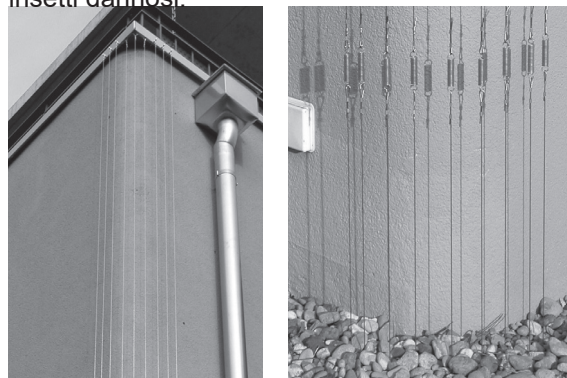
Cavetti metallici di protezione su parti a rischio della facciata e dettaglio degli elementi di tensione (fotografie V. Döbelin).
